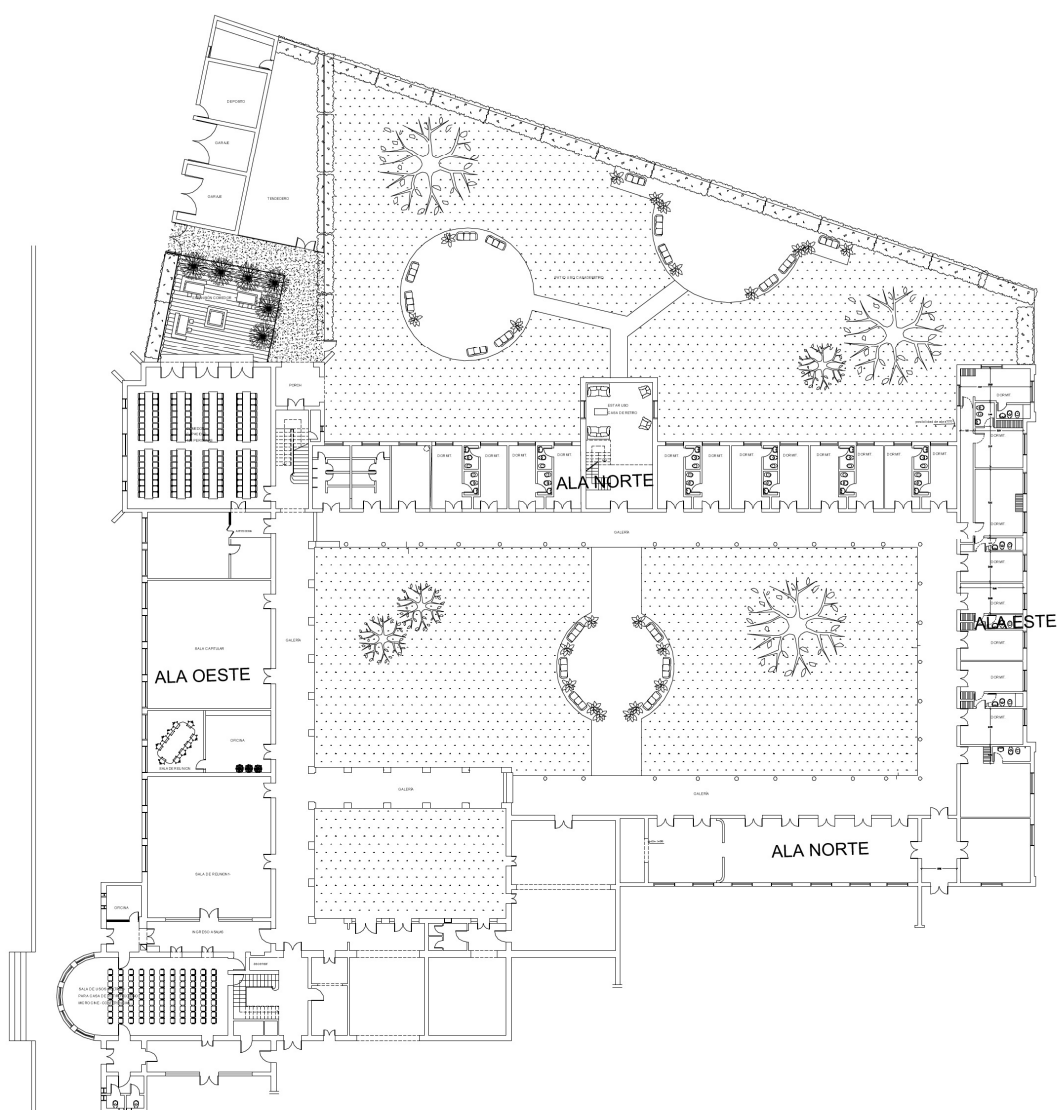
Esquema del plano de Proyecto. Casa de retiro León XIII
